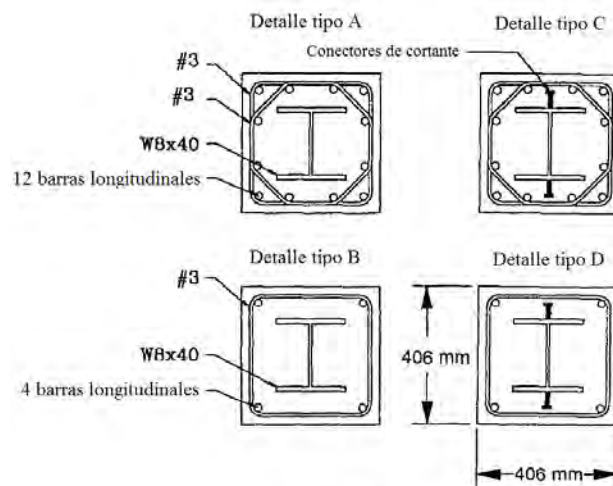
Detallado de especímenes de prueba (Ricles y Paboojian, 1994)
